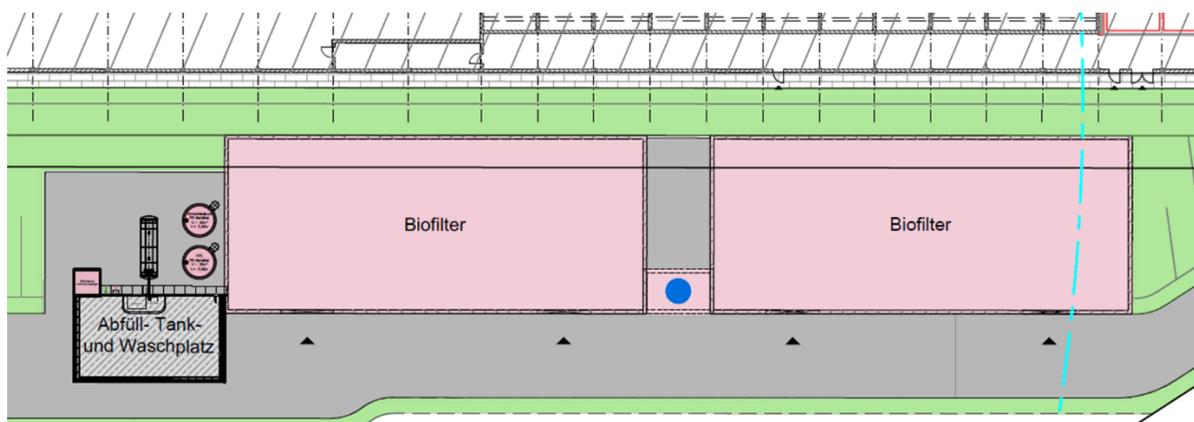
Ausschnitt Lageplan Standortlayout V2; Aufstellung Biofilter
